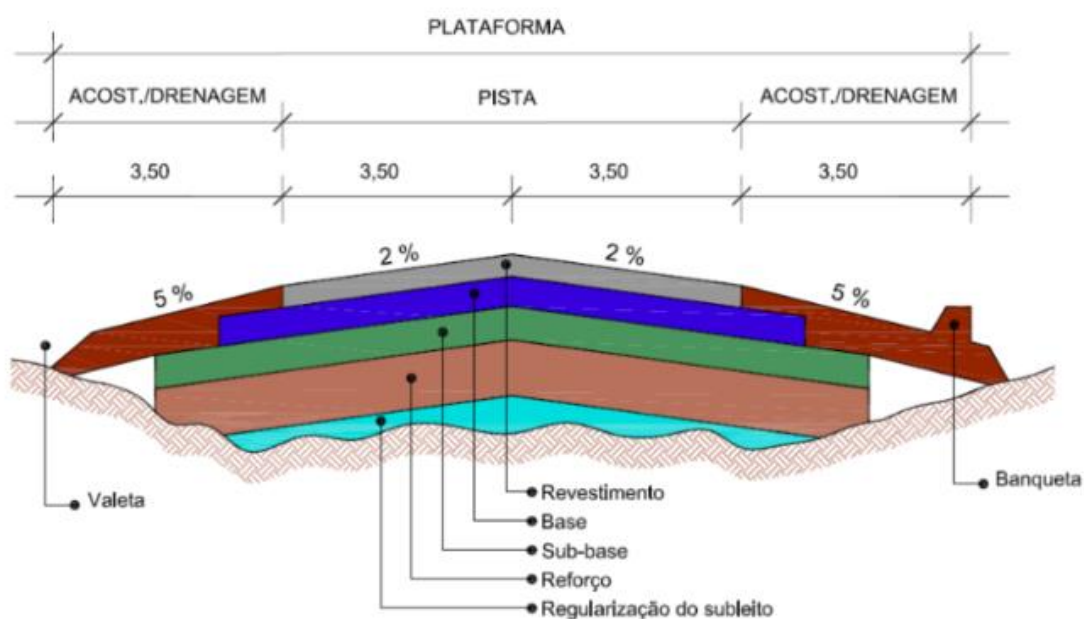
SEÇÃO TRANSVERSAL TÍPICA DE PAVIMENTO FLEXÍVEL
